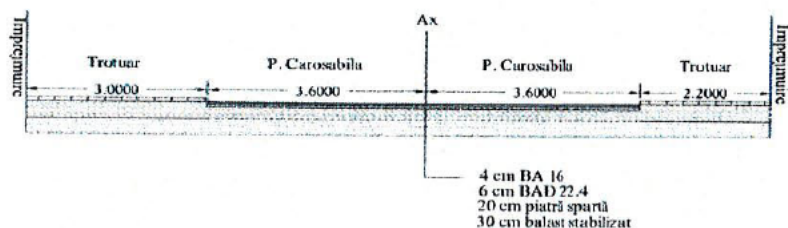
Profil transversal tip – Strada Crizantemelor.
